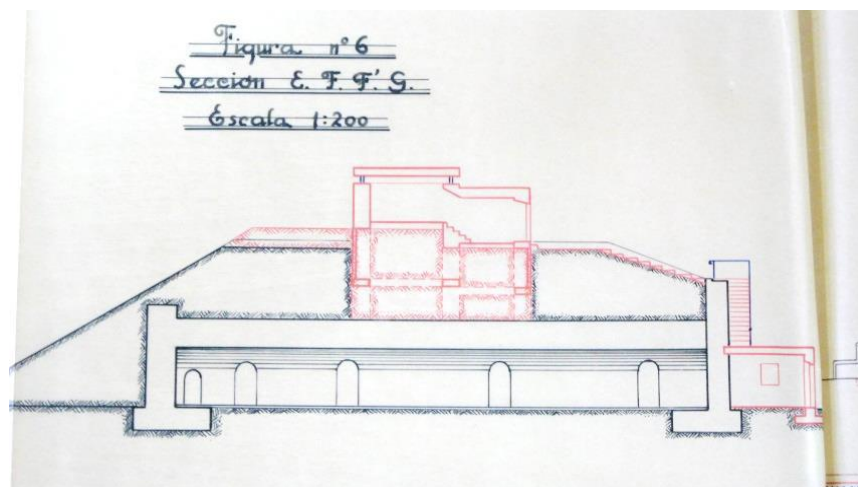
Sección longitudinal anteproyecto Torre y Polvorín. Planos cedidos por el Archivo Militar
